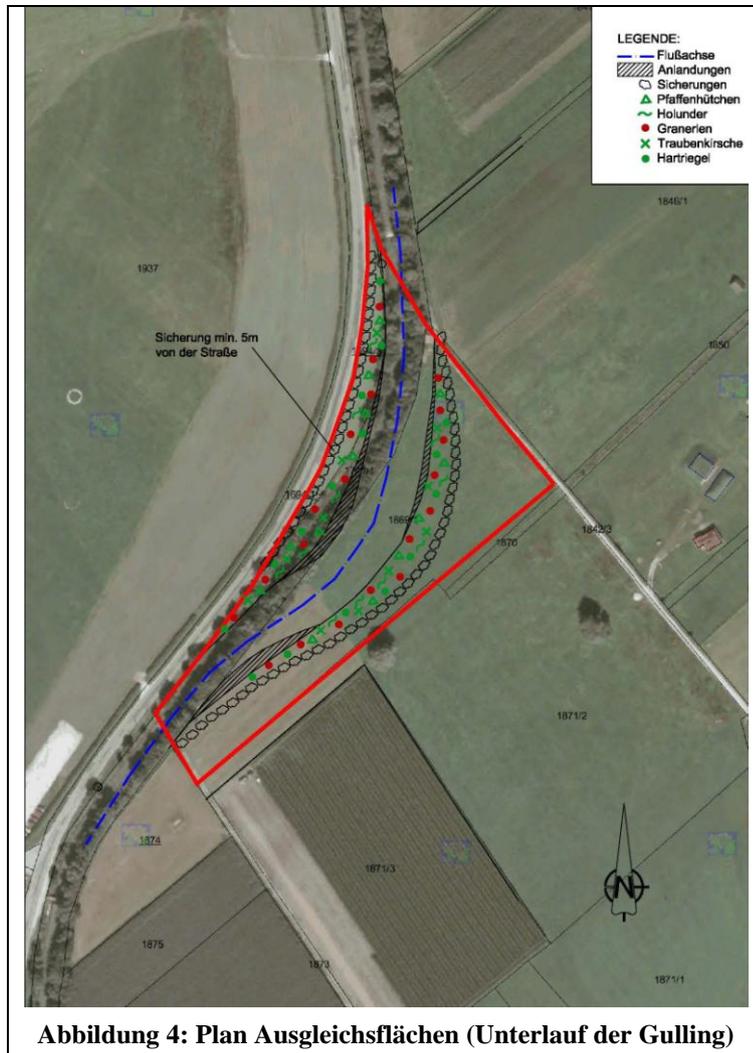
Plan Ausgleichsflächen (Unterlauf der Gullung)
